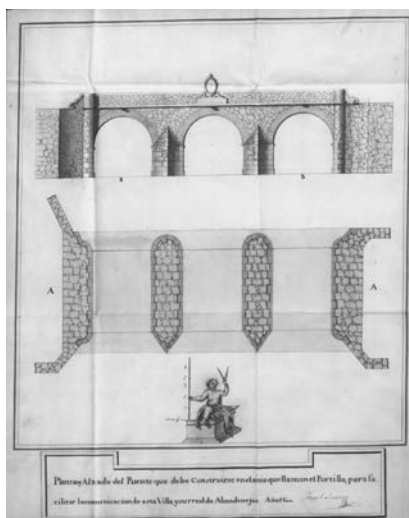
Planta y Alzado del puente¹⁸ que debe construirse en el sitio que llaman “el Portillo”¹⁹, para facilitar la comunicación de esta Villa y su real (sic) de Almadenejos. Fuente: Sierra, 1800.
